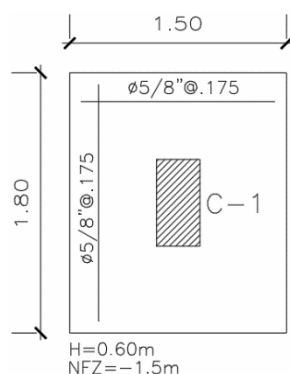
Detalle de armado de la zapata de la columna entre ejes A-3 de sistema de muros
